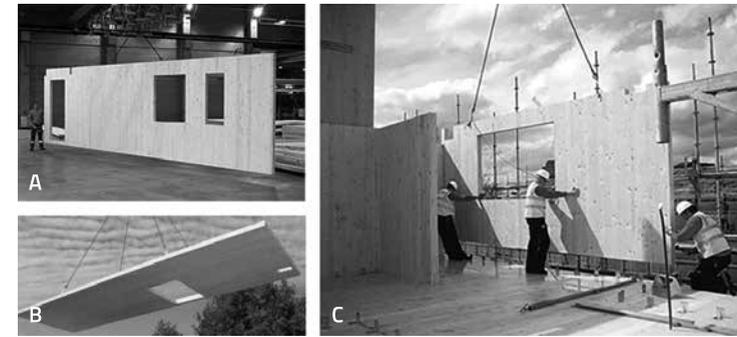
MONTAJE DE PANELES CLT: A) PANEL EN PLANTA. FUENTE: [WWW.GUARDIANSTRUCTURES.CA](http://www.guardianstructures.ca); B) COLOCACIÓN DE UN PANEL DE PARED EN OBRA. FUENTE: [WWW.WOODSKYSCRAPERS.COM](http://www.woodskyscrapers.com); C) COLOCACIÓN DE UN PANEL DE LOSA EN OBRA. FUENTE: [WWW.TREEHUGGER.COM](http://www.treehugger.com)
